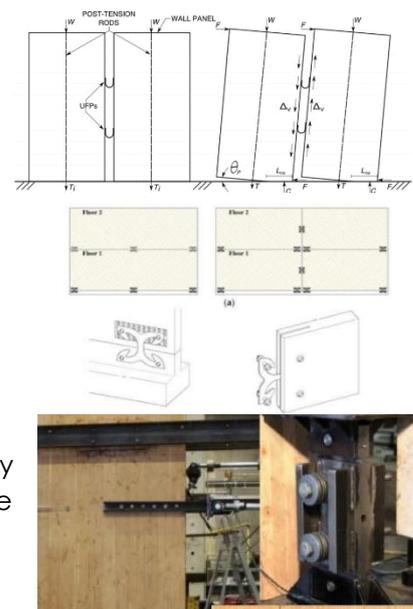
Detalle constructivo genérico (Fuente Polo Madera)
